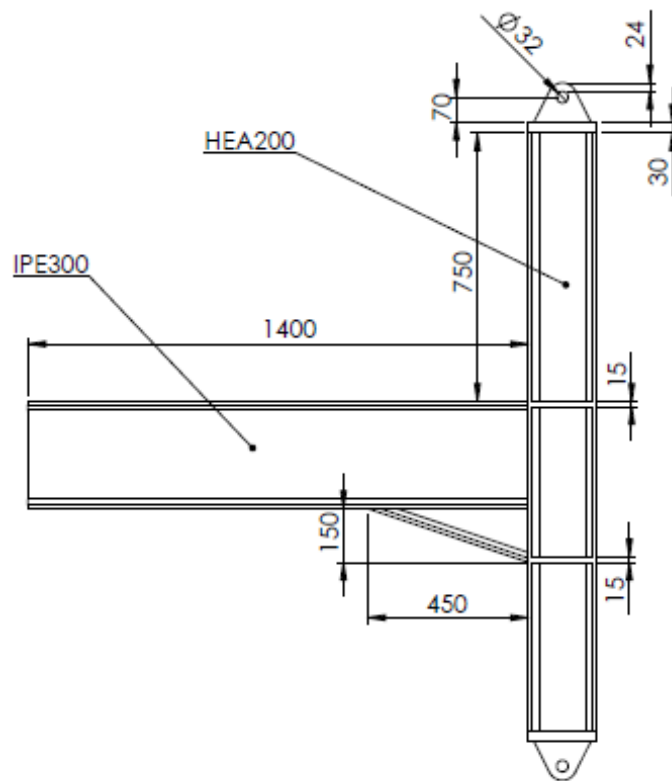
Modelo 2. Unión viga-pilar con dos rigidizadores. (Fuente: elaboración propia)
